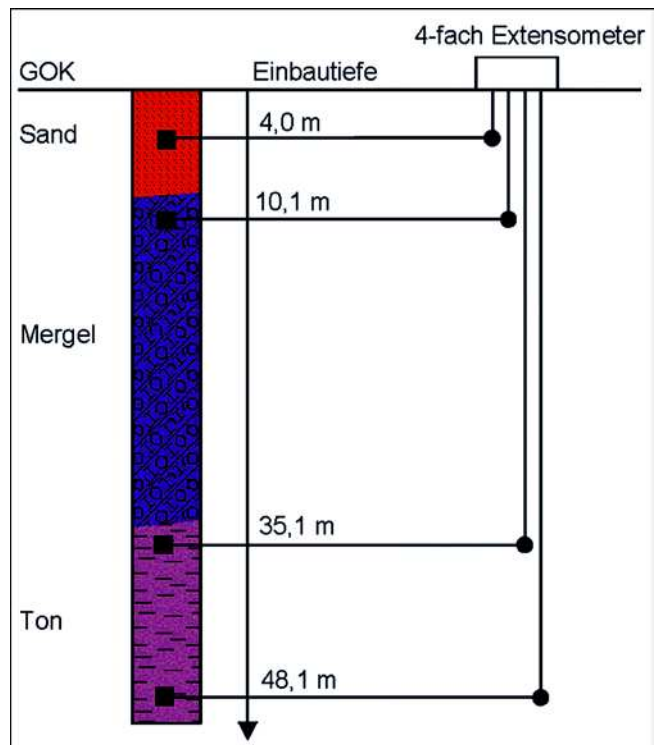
Baugrundaufbau und Tiefenlage der eingebauten Extensometeranker
